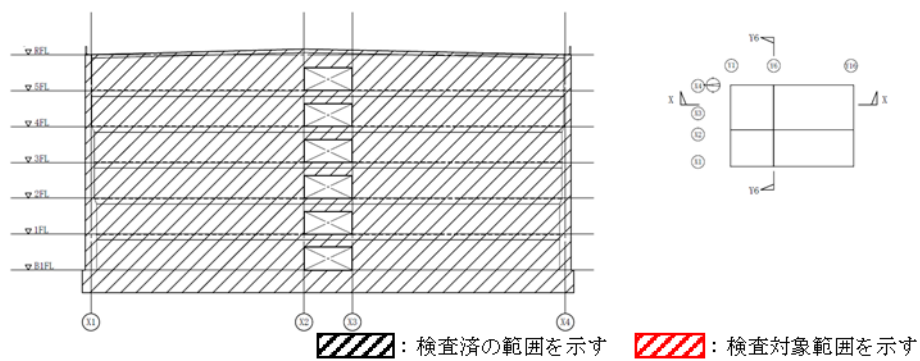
構造強度・耐震性を確認する範囲を示した図 東西方向Y6断面図 (9 / 9)
